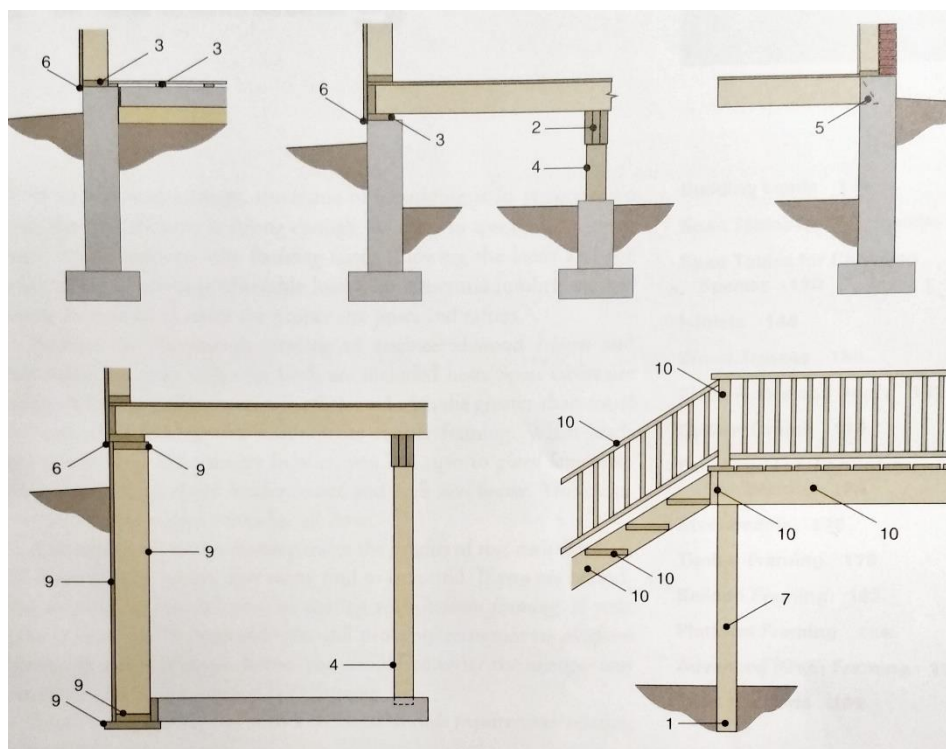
Componentes e elementos onde o IBC exige madeira tratada (Wing, 2009). 1 - Pilares em contacto com o solo; 2 - Vigas próximas do solo; 3 - Travessas assentes em elementos de betão; 4 - Pilares assentes em elementos de betão ou alvenaria; 5 - Vigas e vigotas encastradas em paredes; 6 - Juntas de estruturas de madeira próximas do solo; 7 - Estruturas de madeira que suportam decks ou escadas permeáveis à água; 8 - Paredes de contenção com elementos de madeira; 9 - Fundações com elementos de madeira; 10 - Elementos de guardas e escadas expostos.
